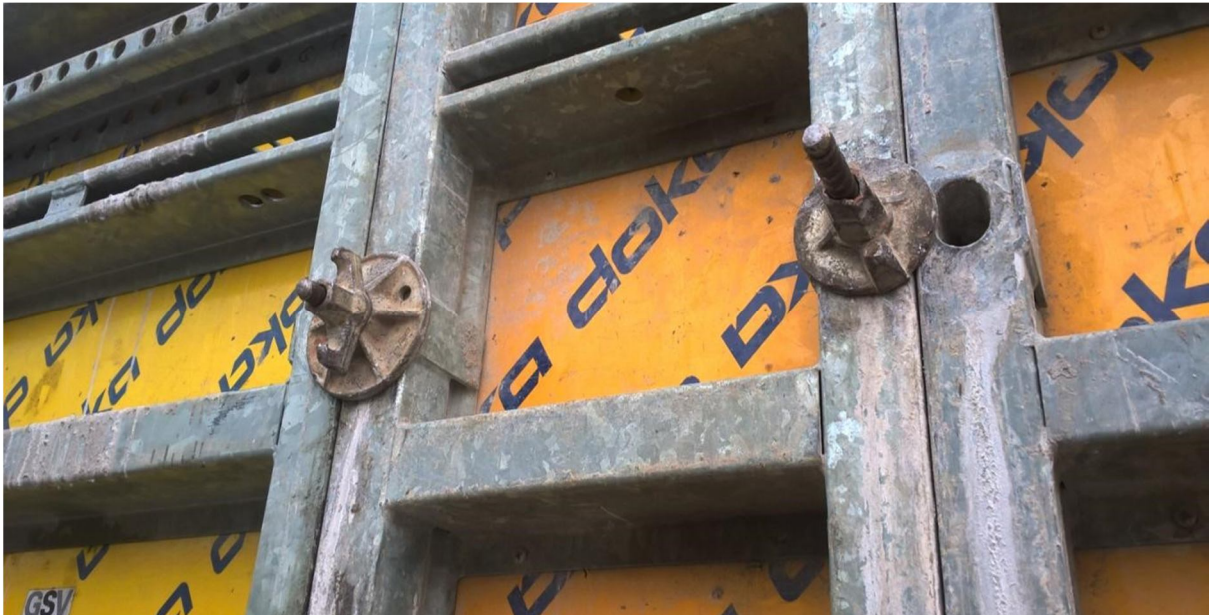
Влаштування анкерних стяжок в щитах опалубки
